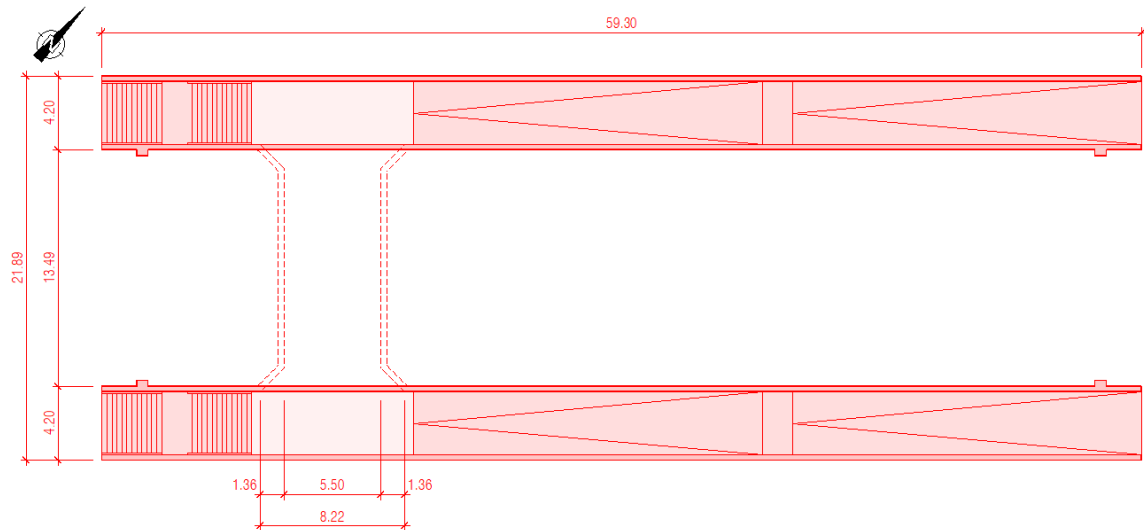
Grundriss Personenunterführung + Aufgänge
